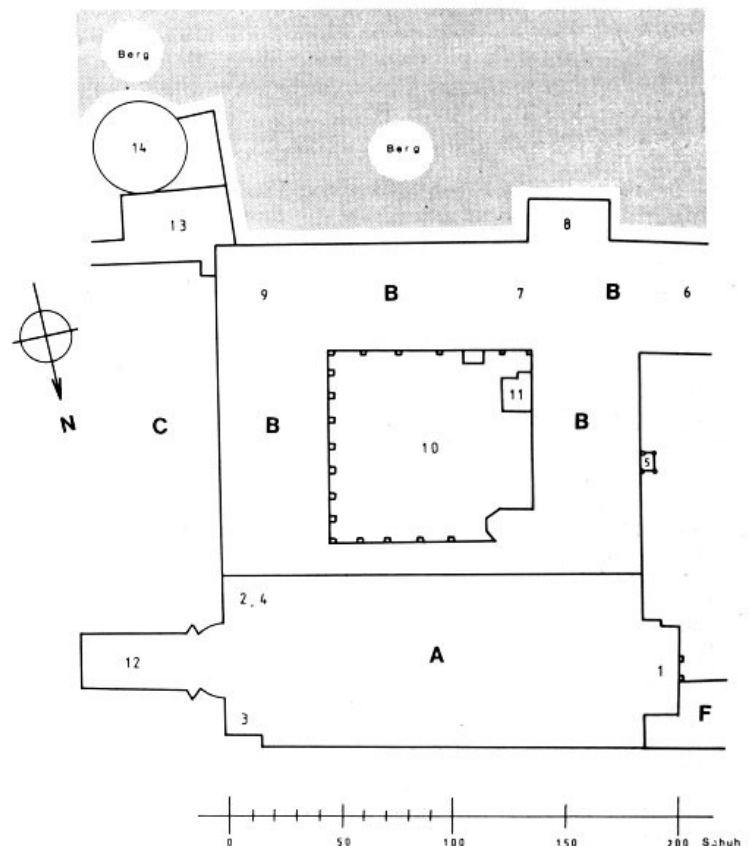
Weihenstephan im Jahre 1803. Plan nach Th. Heigl, BayHStA Plansammlung 6397.
